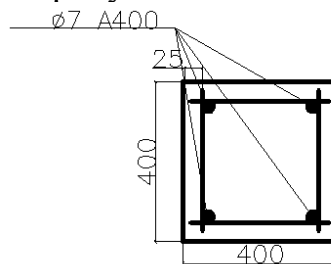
Армирование и сечение колонны первого этажа
